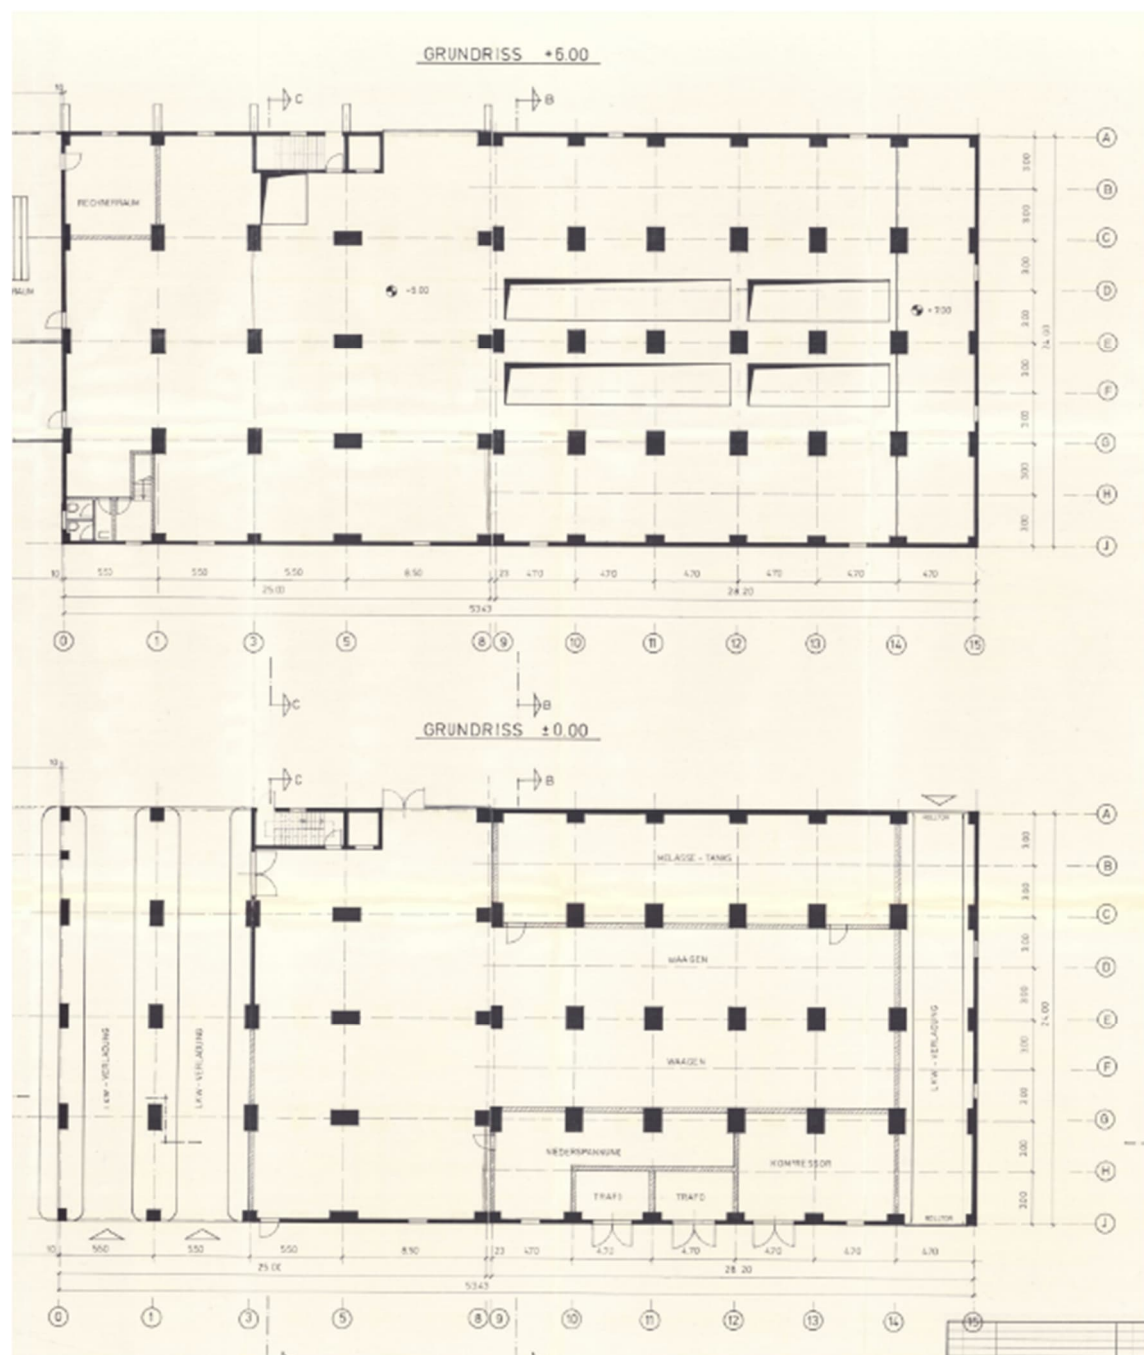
Bestandsgrundrisse Erdgeschoß und 1. Obergeschoß Gebäude A1
